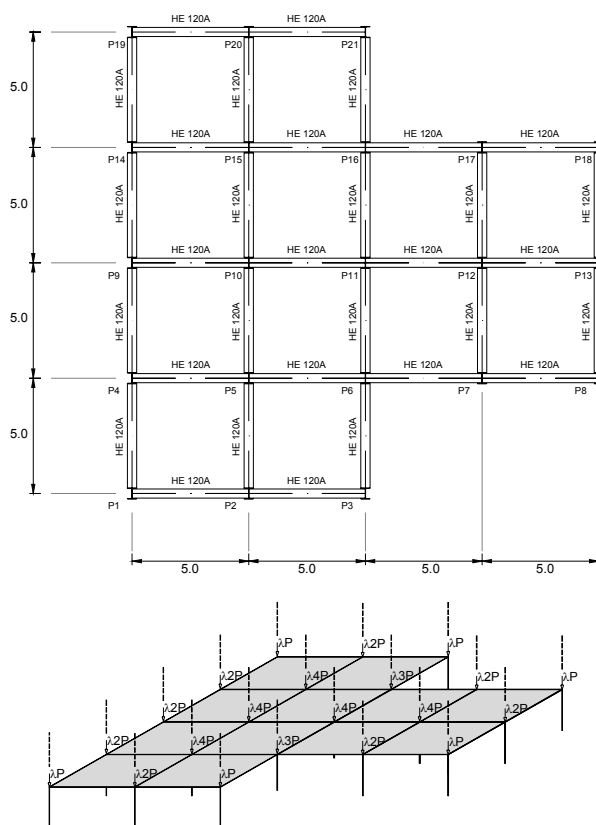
Planta do edifício 3D com 10 pisos e respectivo carregamento
